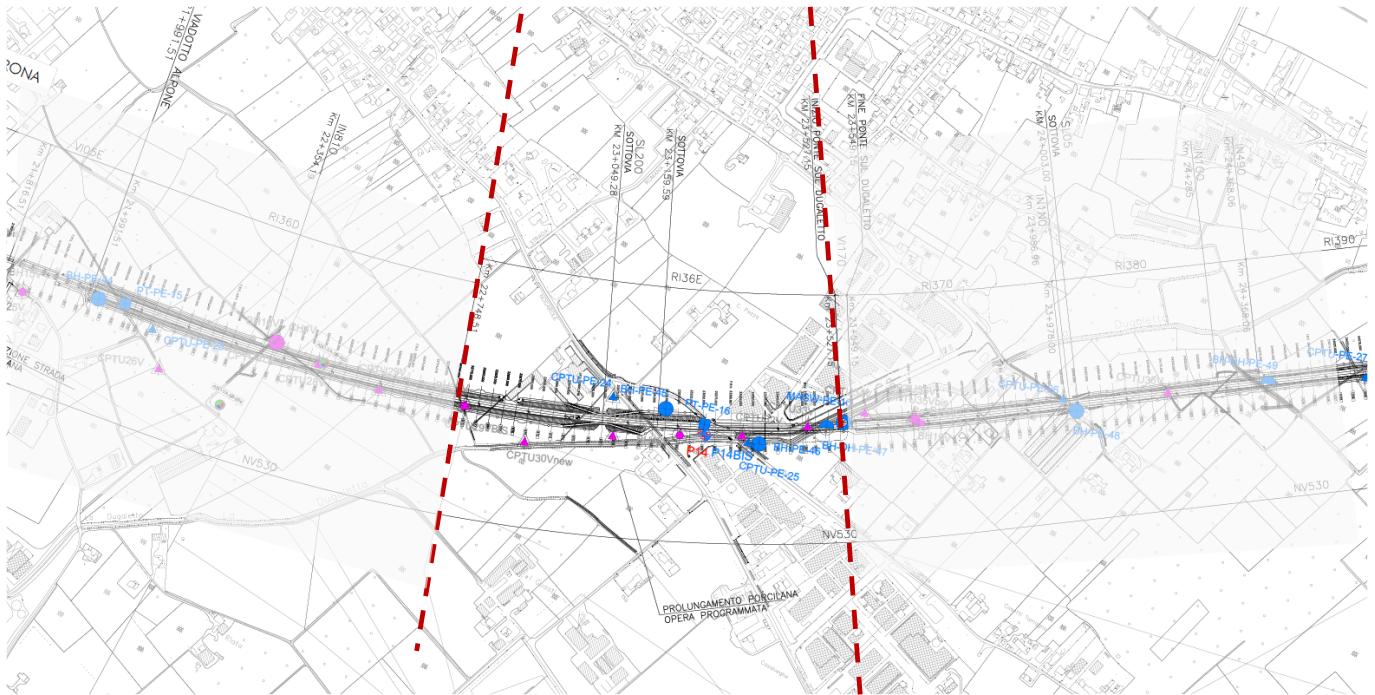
Planimetria Rilevato RI36E, estratto dalla Planimetria Generale (Doc. Rif. [3])
